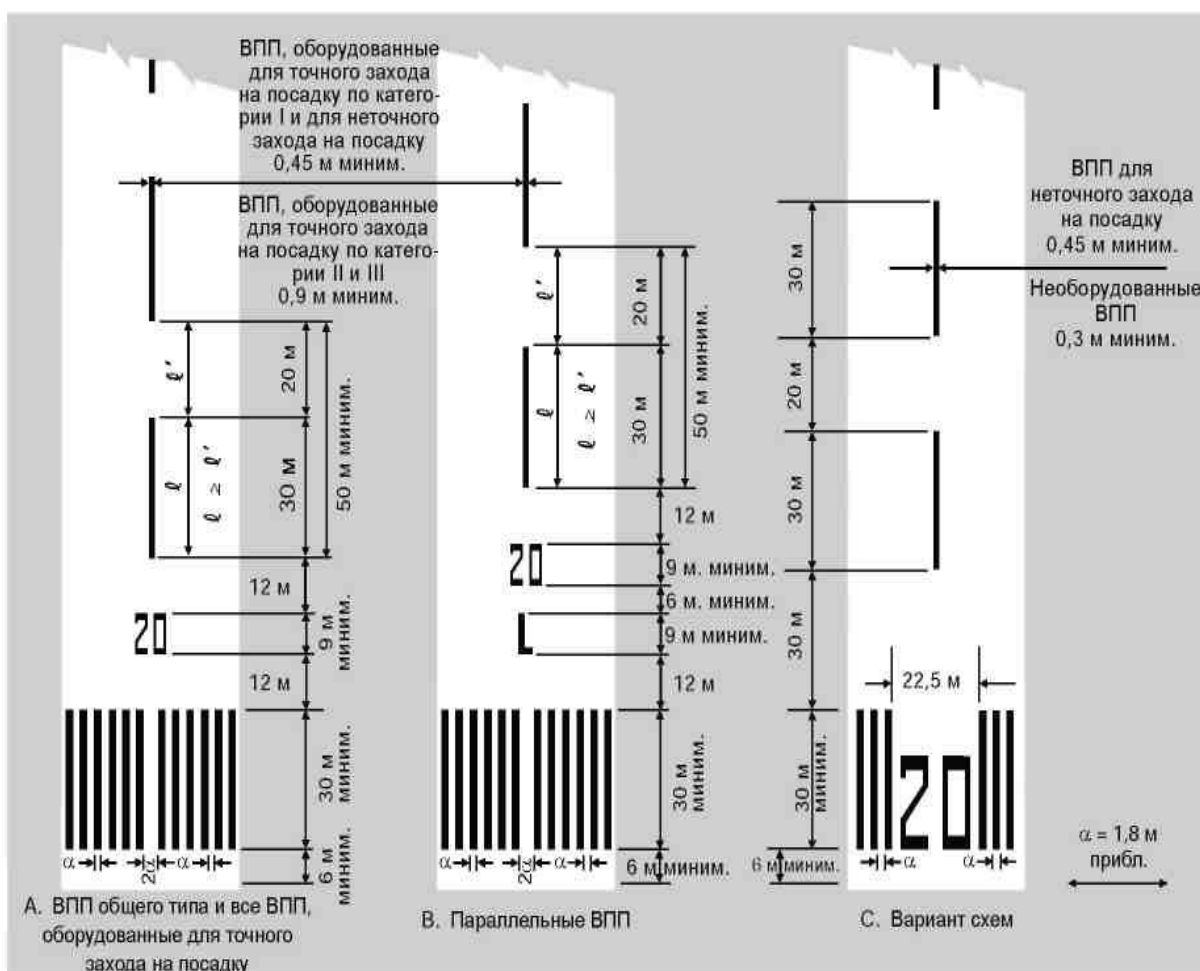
Маркировка обозначения ИВПП, её осевой линии и порога
